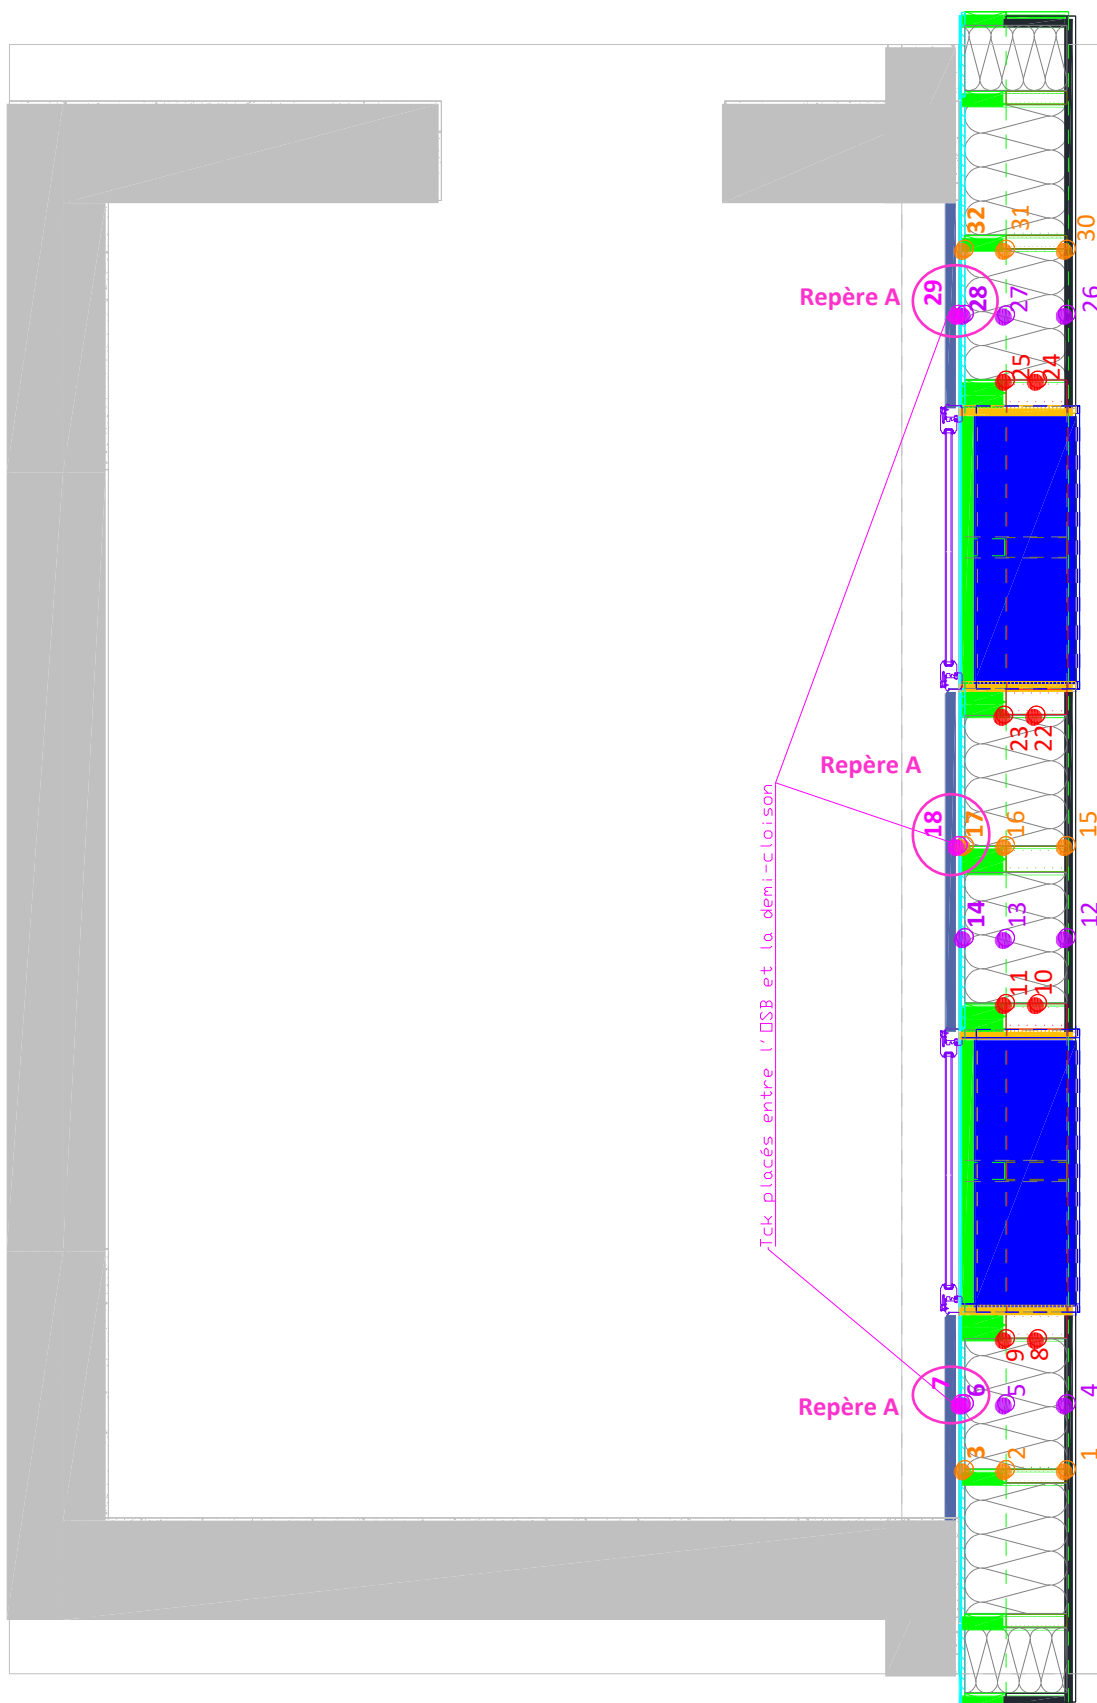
Instrumentation de l'élément de façade - Coupe I-I
